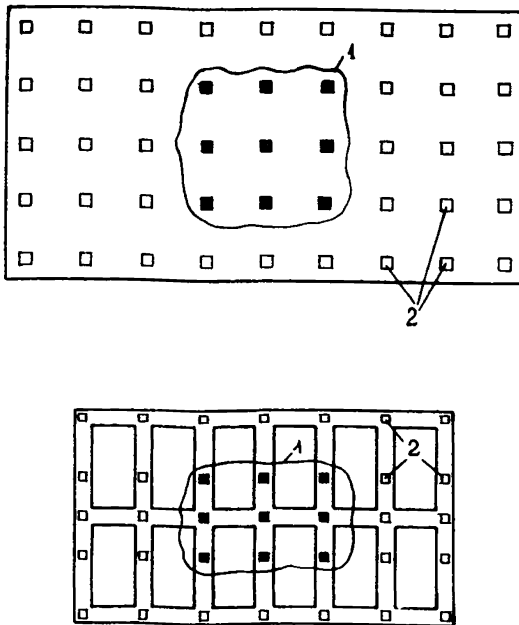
Схемы свайных фундаментов с комбинированной заделкой голов свай в ростверк: а-свайное поле при плитном ростверке; б-свайное поле при ленточном ростверке, 1-сваи с жесткой заделкой голов в ростверк; 2-сваи с шарнирной заделкой голов в ростверк или с сопряжением через шов скольжения.
